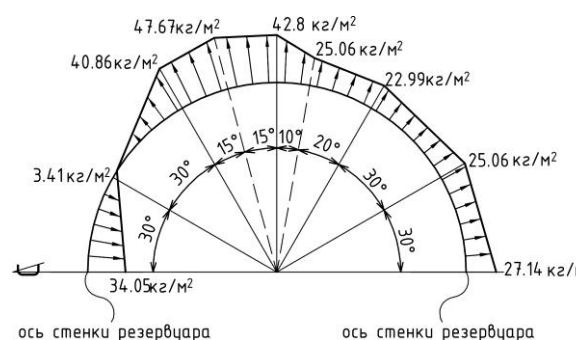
Схема приложения ветровой нагрузки на 6-й пояс стенки резервуара
